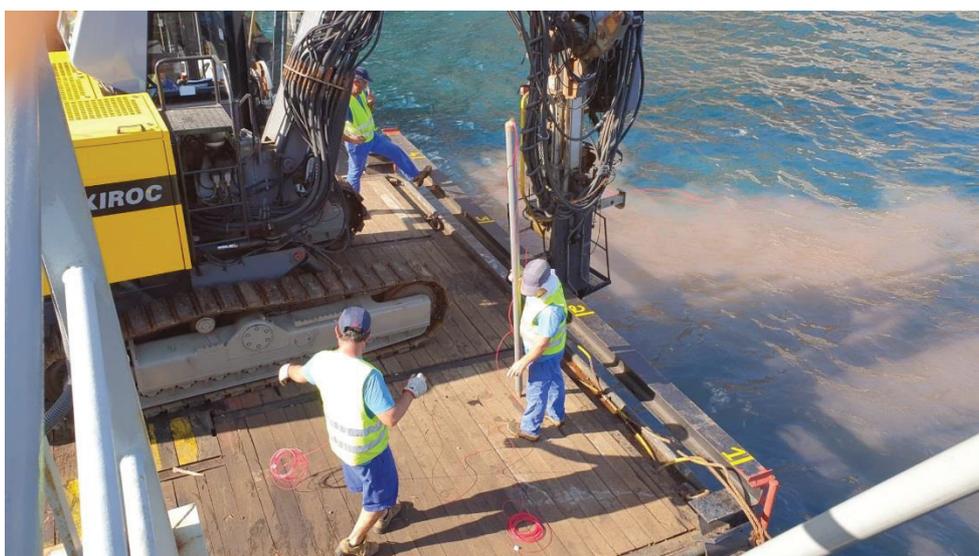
Trabalhos de dinamitação e dragagem. Fonte: Acervo de Pedro Parreira.
